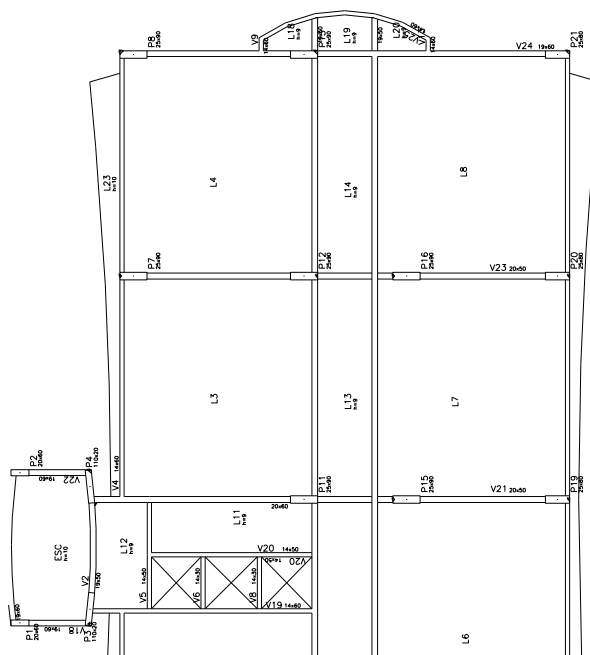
Edifício HC Plaza – Vigas altas + Lajes maciças.
